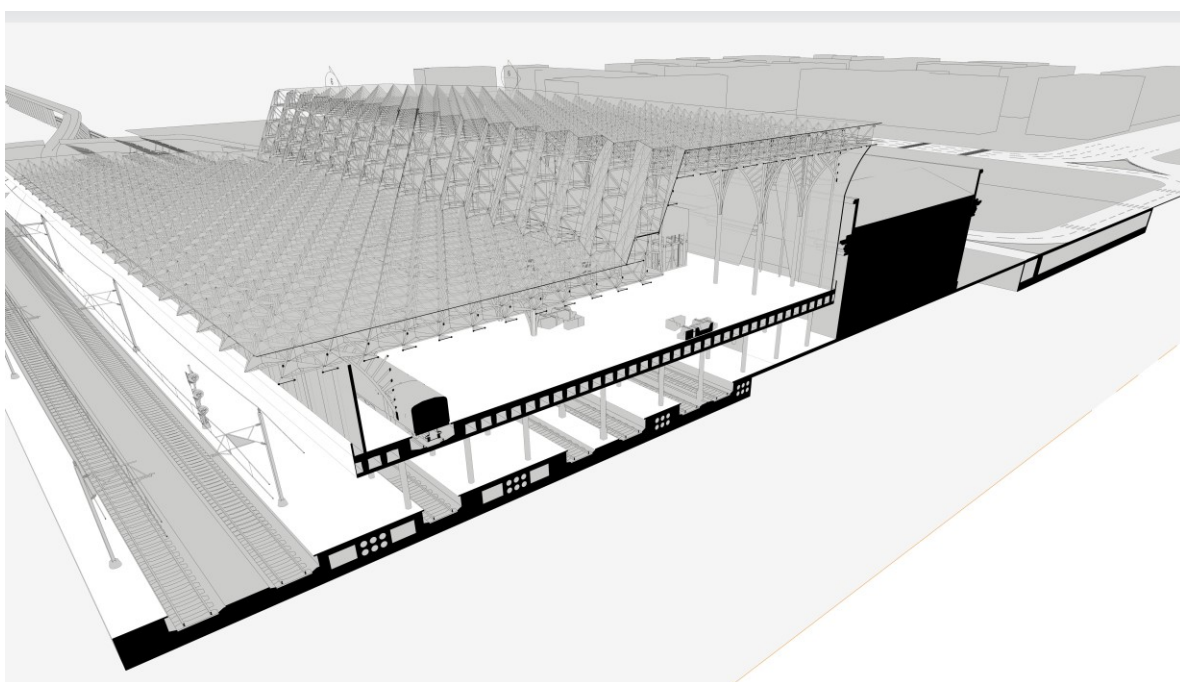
Поперечный 3D разрез (Чертеж автора).
